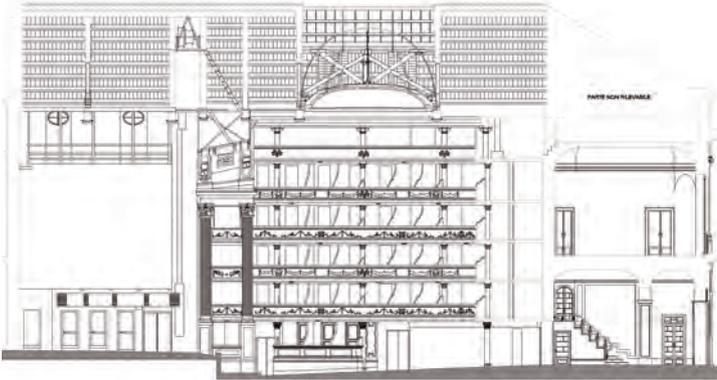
Restituzione del rilievo longimetrico della sezione longitudinale del teatro
